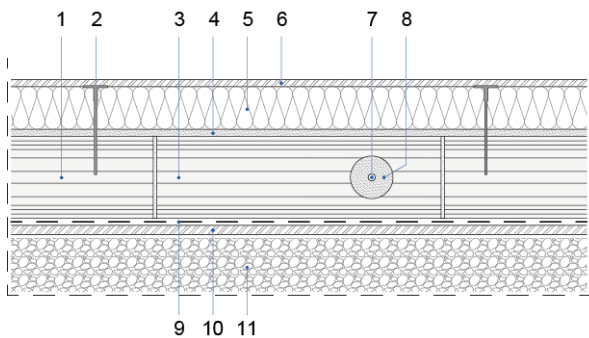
Fachada. Encuentro con peto. Sección horizontal.
